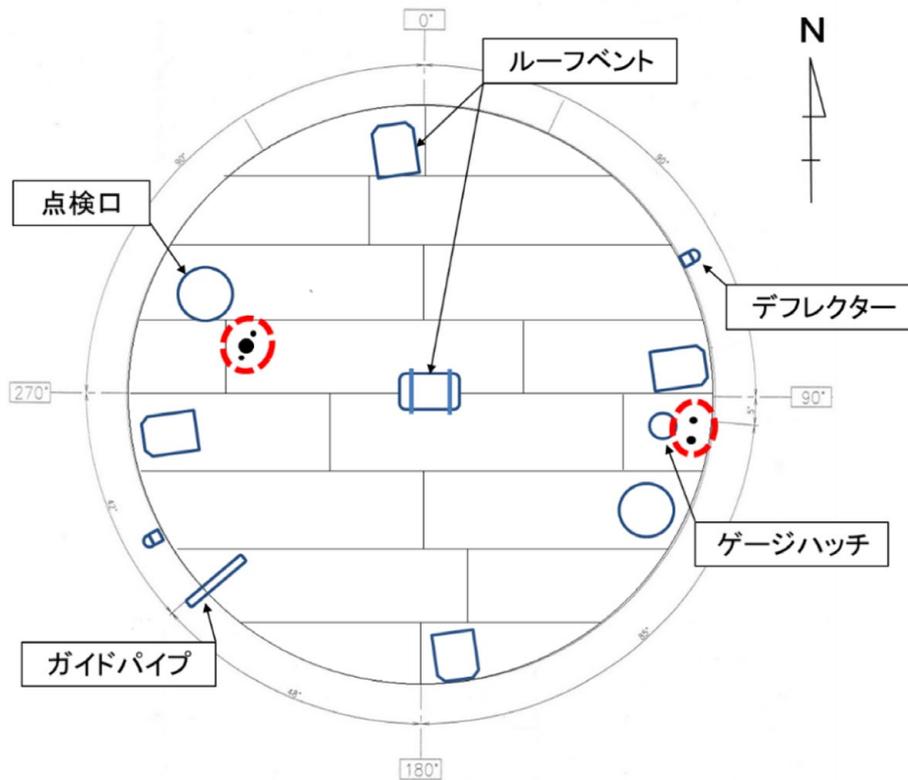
タンクの平面図及び屋根板変形箇所（点線赤丸）
